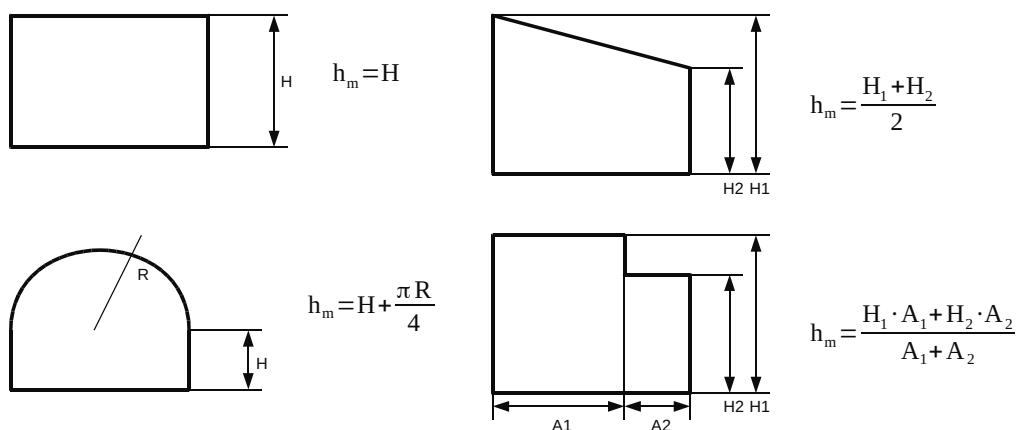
Esempi di determinazione dell'altezza media, in sezione
